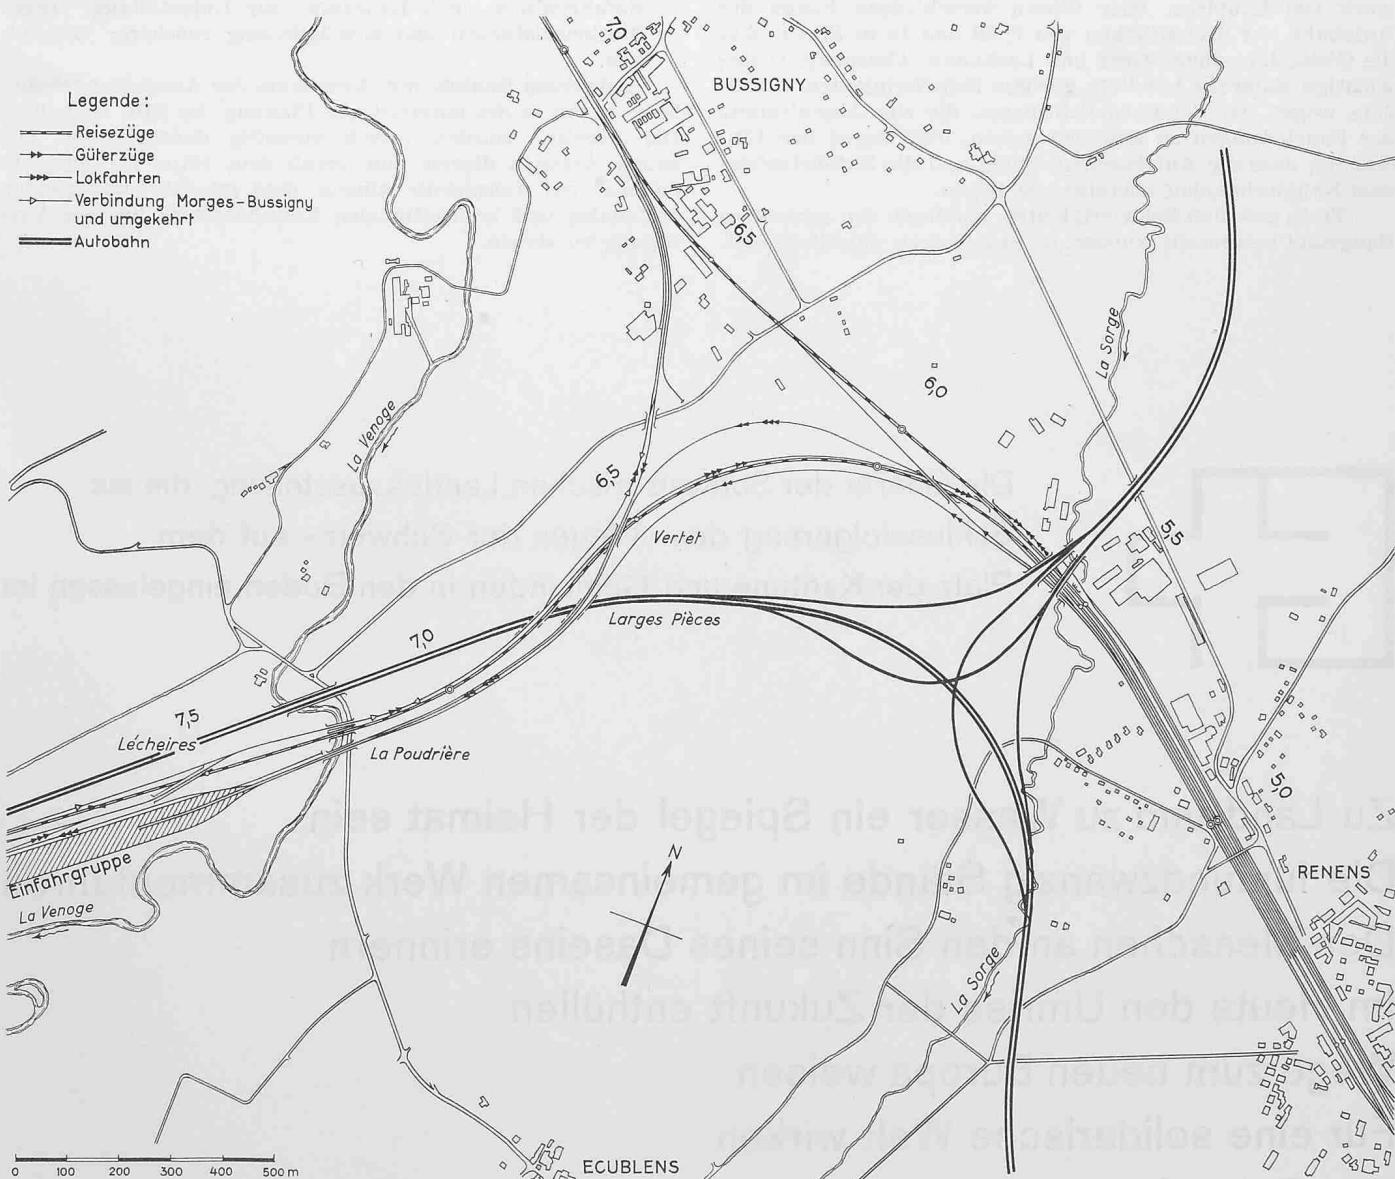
Rangierbahnhof Lausanne-triage der Schweiz. Bundesbahnen, Lageplan 1:15 000 (rechte Hälfte)
